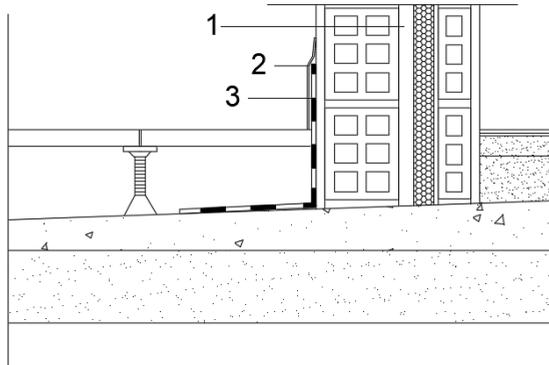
Detalle Encuentro pavimento exterior con fachada. Fuente: Propia de la autora
